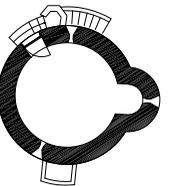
Grundriss Kerbitz/Grill 2009. M 1:400.
